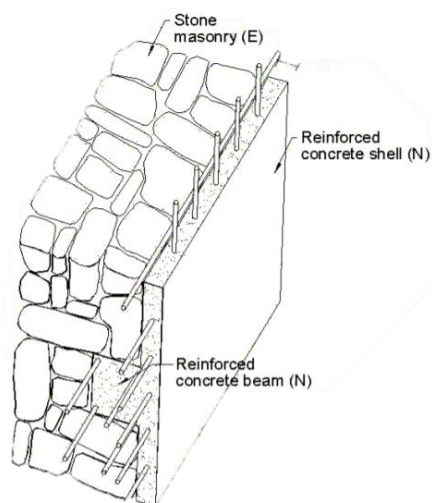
Representação esquemática de parede de alvenaria de pedra reforçada com reboco armado
